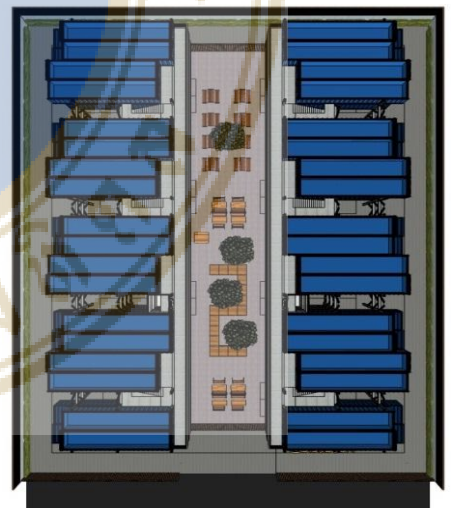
The Ccontaindy apartment 1st floor plan
